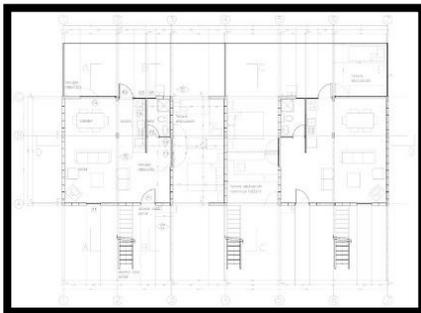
Plan du RDC du projet (Source:archdaily.com).
